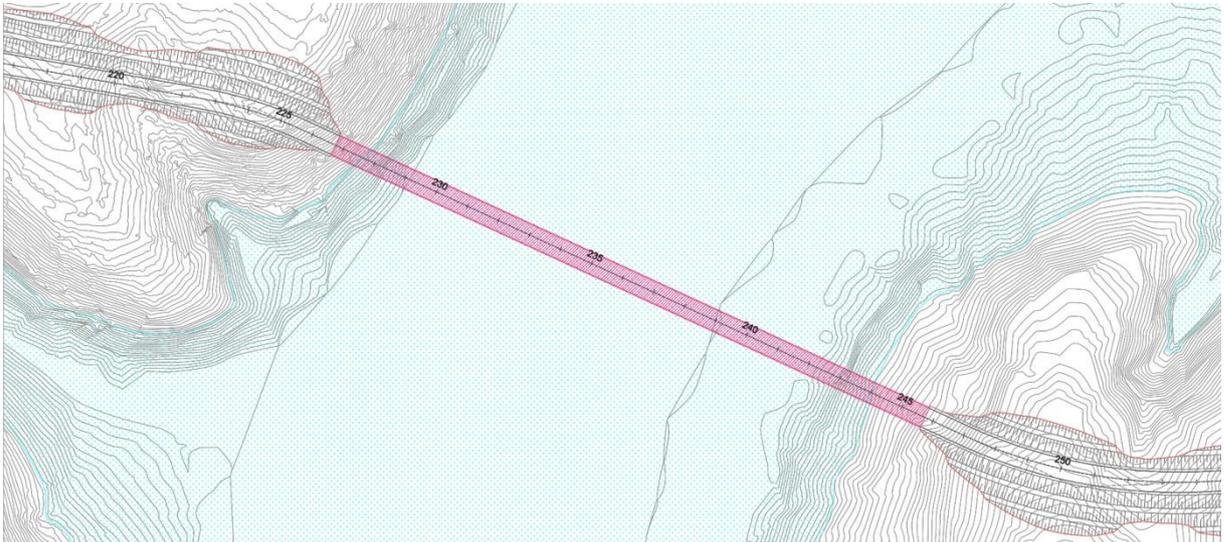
Croqui de Implantação da Ponte (Preliminar)
